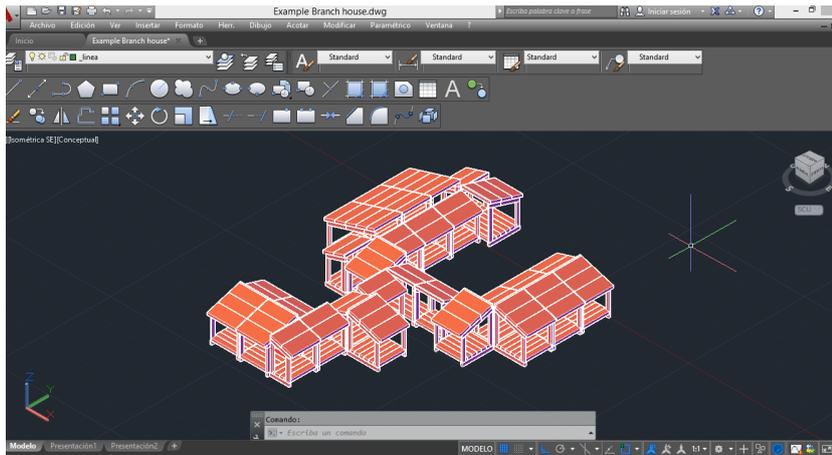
Volumetría 3D en AutoCAD del Espansiva Building System, de Jørn Utzon.
